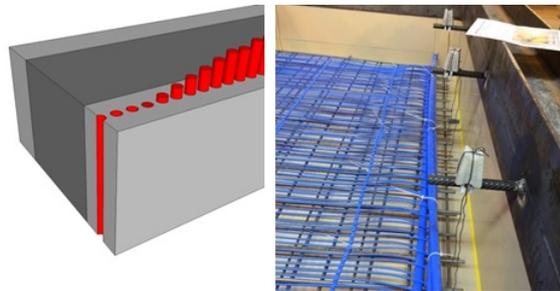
Dreischichtige Bauteilkonfiguration mit Bauteilaktivierung in der äußeren Lage (links); Einbau der Kapillarrohrmatte auf der Bewehrungslage (rechts) (Quelle: Transsolar Energietechnik)
